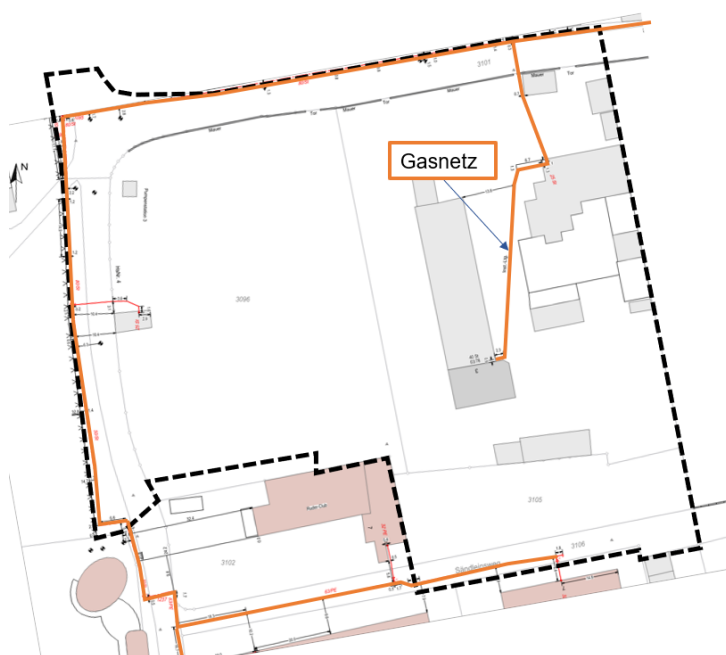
Lageplan örtliches Gasnetz (Stadtwerk Karlstadt)
